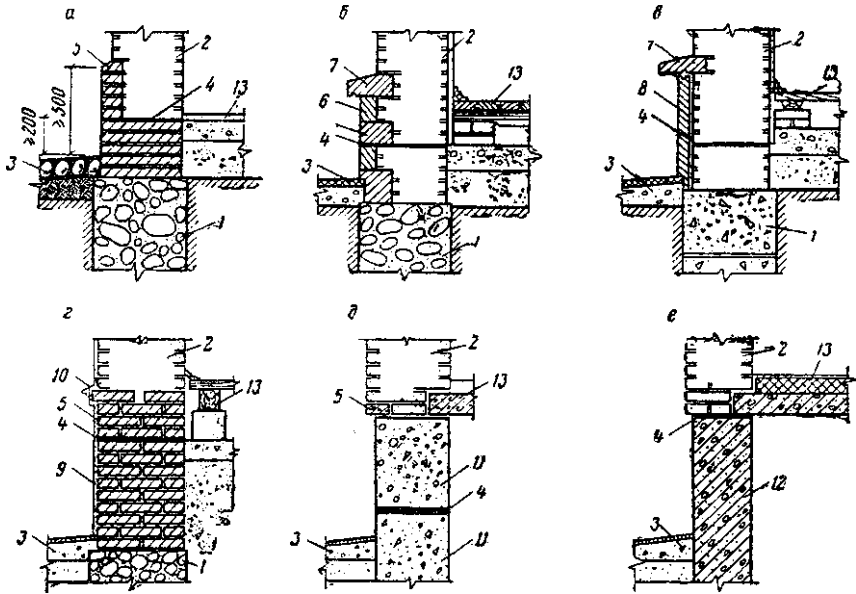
Тип конструкцій цоколя: а - обкладений цеглою; б - обкладений камінними блоками; в - обкладений плитами; г - оштукатурений; д - з бетонних блоків; е - з залізобетонних панелей; 1 - фундамент; 2 - стіна; 3 - відмощення; 4 - гідроізоляція; 5 - цегла; 6 - цокольні кам'яні блоки; 7 - бортові цокольні камені; 8 - облицювальні плити; 9 - штукатурка; 10 - покрівельна сталь; 11 - бетонний блок; 12 - панель фундаментної стіни; 13 - конструкція підлоги першого поверху
